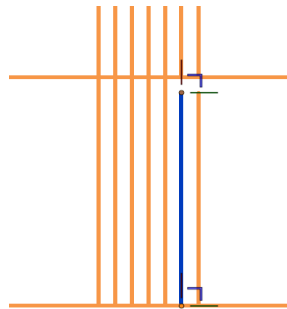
Vista em alçado para a correção do modelo analítico dos pilares
